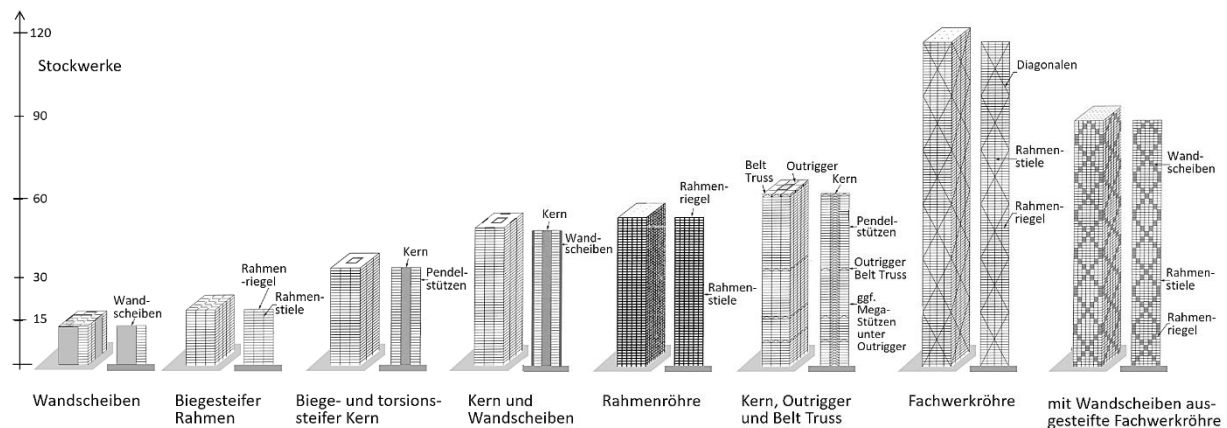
Gebräuchliche Aussteifungssysteme für Stahl und Stahlbetongebäude und zugehörige, sehr grobe Höhenangaben nach [2]
